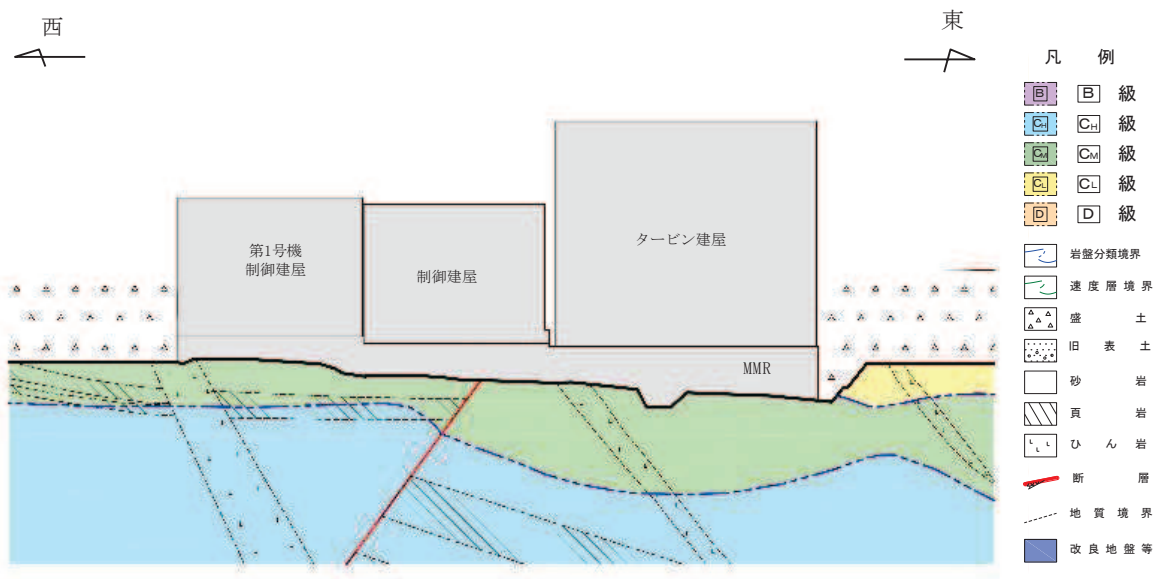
制御建屋の地質断面図 (③-③断面)
